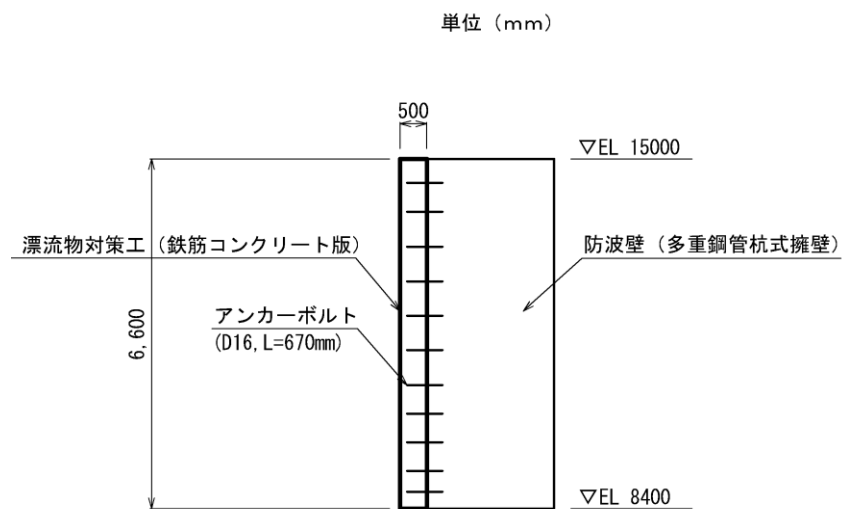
(2) 漂流物対策工 (鉄筋コンクリート版) のアンカーボルト配置図 (断面図)
